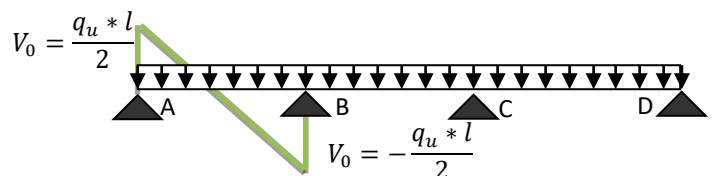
Schéma statique d'une Poutrelle : Type -4- étages Courants et son effort tranchant
